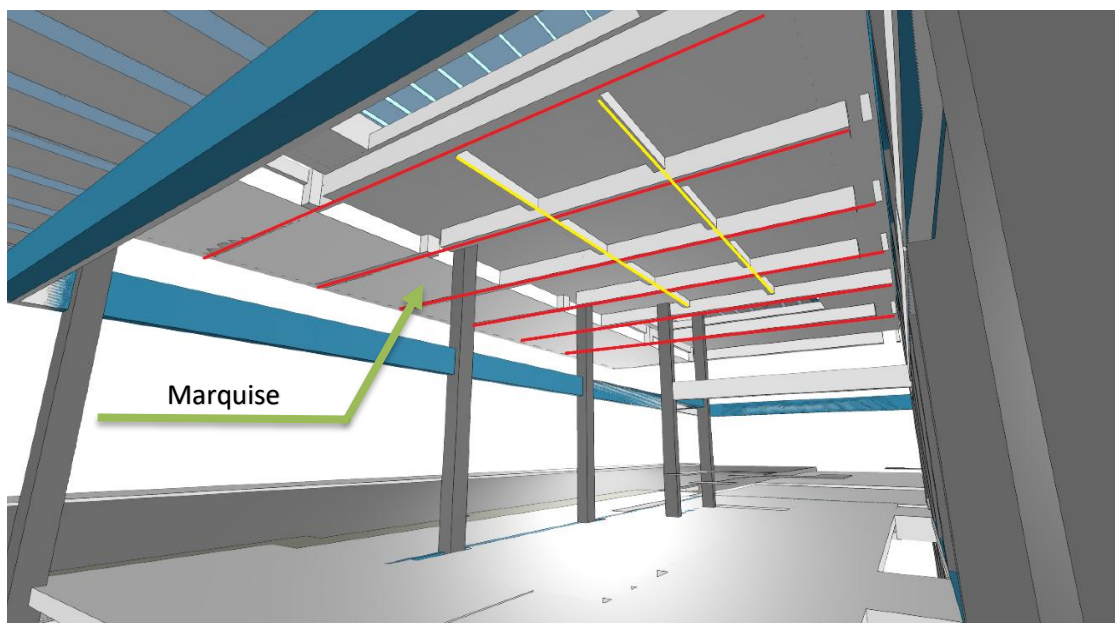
Vista 3D do levantamento da estrutura “as built” da laje sobre Foyer
